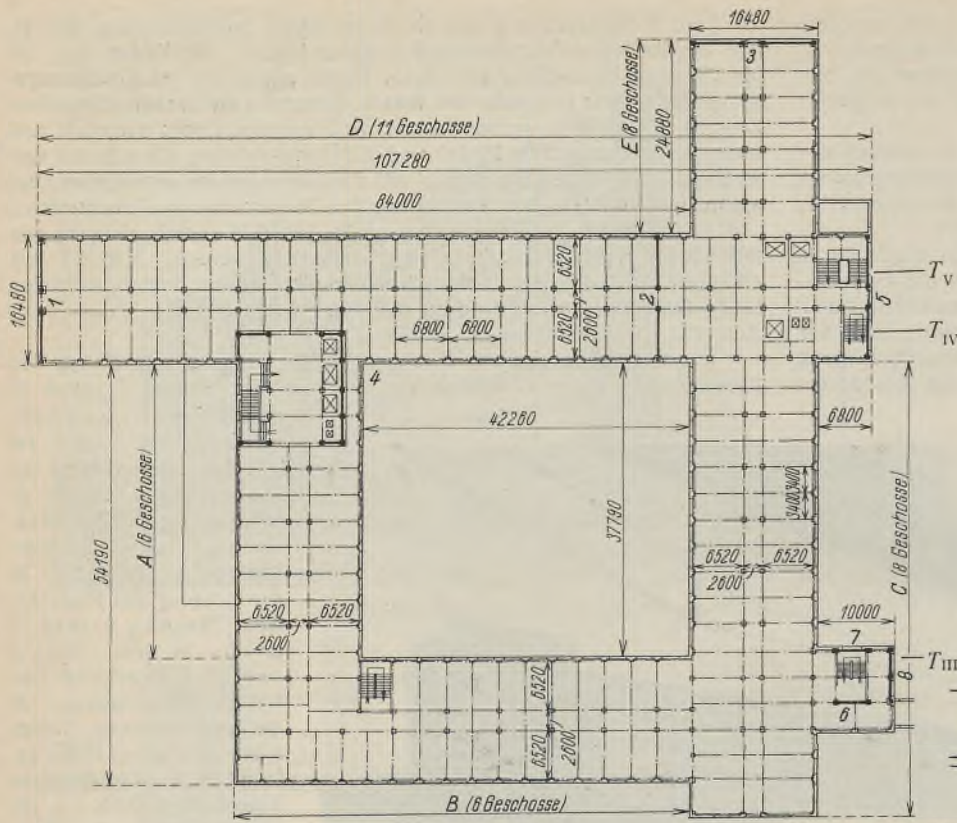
Grundriß des Wernerwerks in Siemensstadt.
